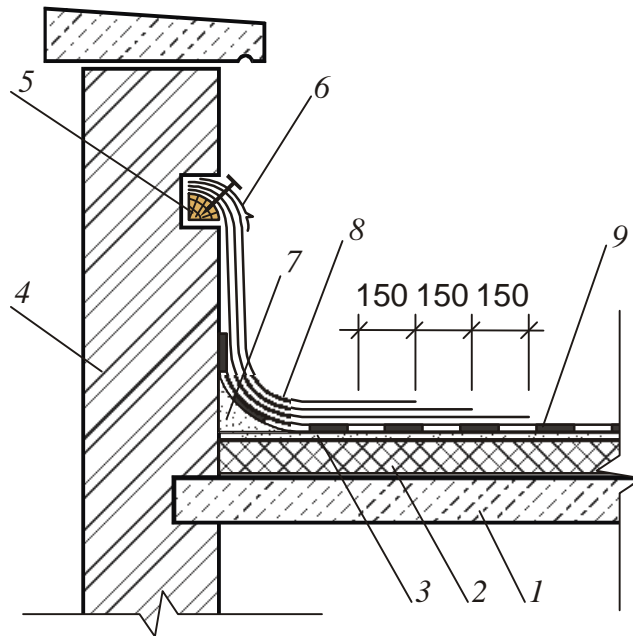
Ремонт примыкания кровельного покрытия к парапету:
